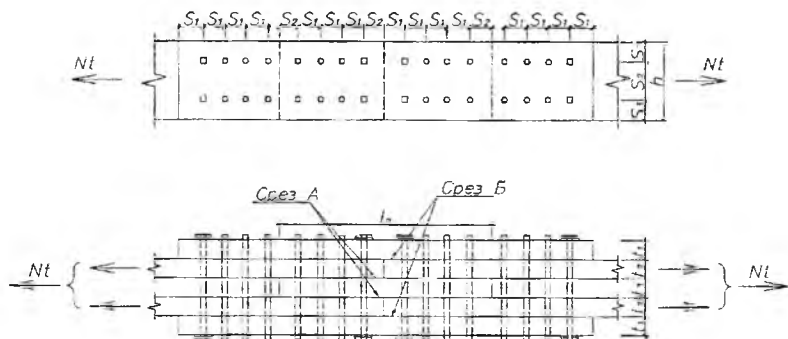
Стык нижнего дощатого пояса фермы на цилиндрических нагелях с удлиненными накладками
